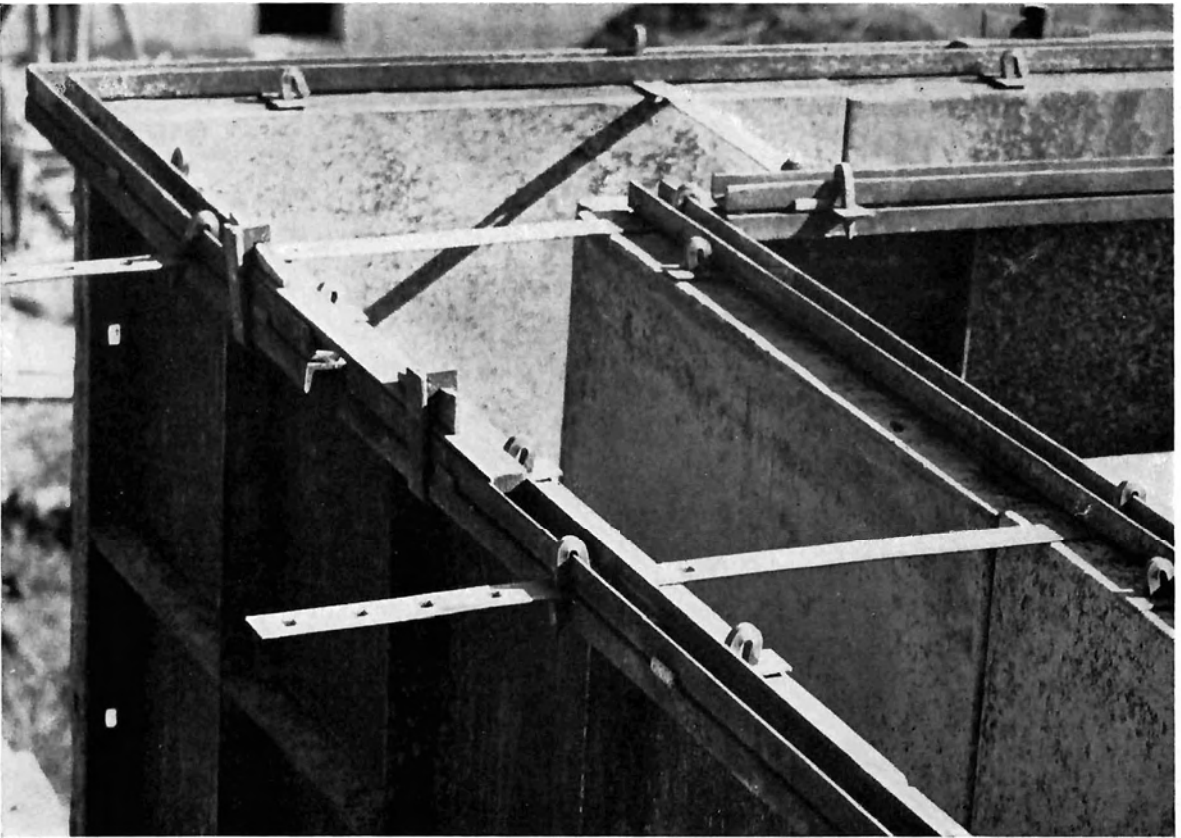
Befestigungselemente und Schleifbleche der Stahl-Bauschalung
